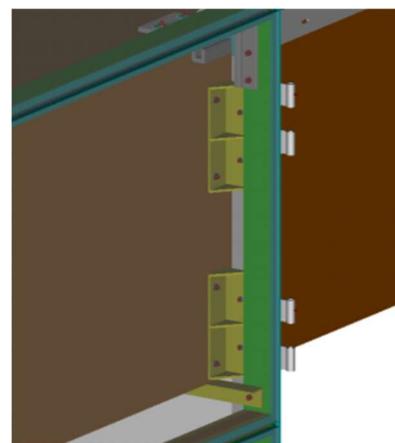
Detalhamento das dobradiças instaladas. FONTE: Relatório Petrucci Consultoria e Engenharia. Plano de desmontagem da fachada cortina (21/12/2017).
